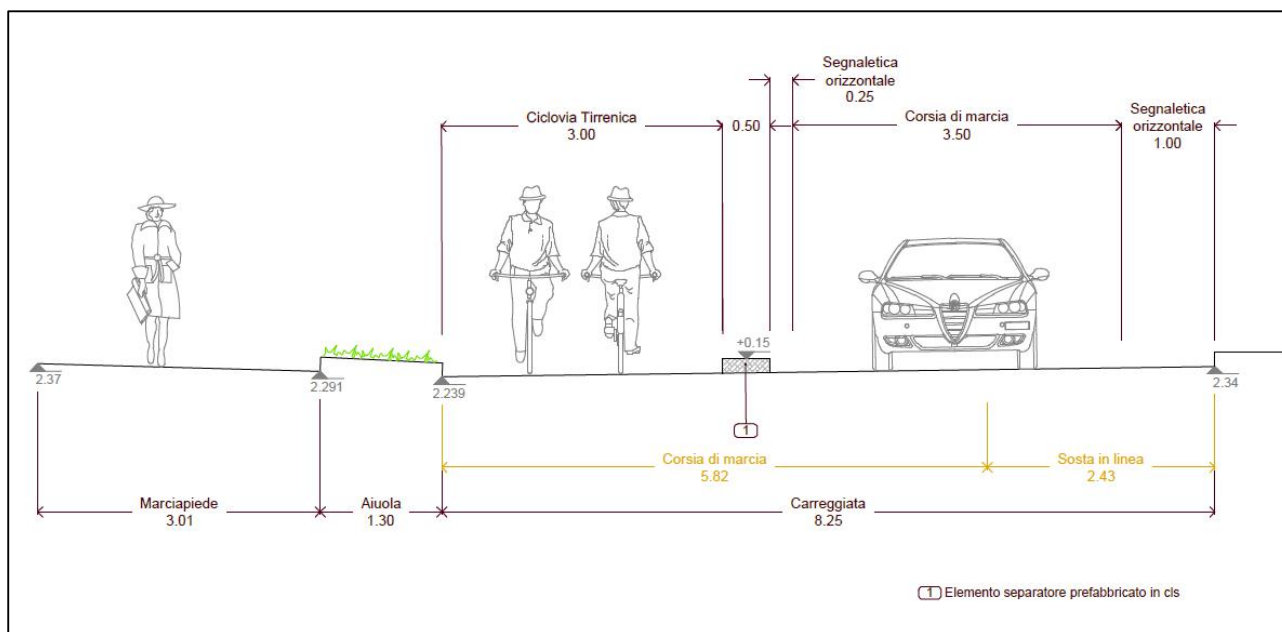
Sezione 07 di progetto trasversale su Viale Carducci
